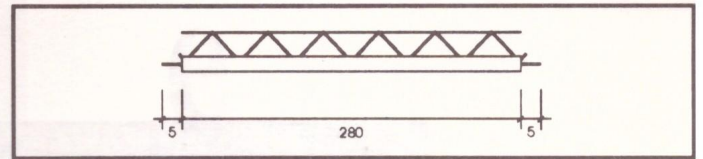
Vista esquemática da viga treliçada com excesso de ferragem adicional
